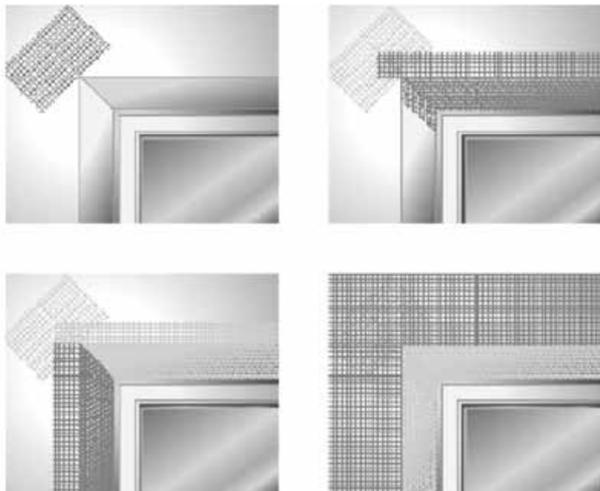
Necesario reforzar jambas y dinteles de los huecos de fachada con fajas de armadura de fibra de vidrio.
